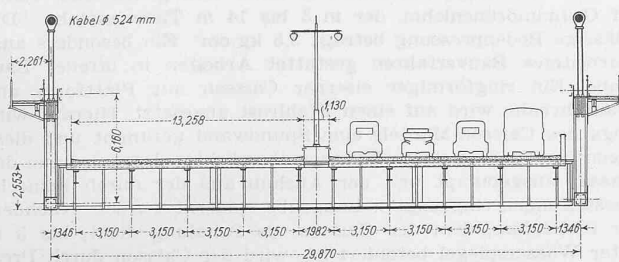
Querschnitt 1: 400 der Triborough Bridge.
